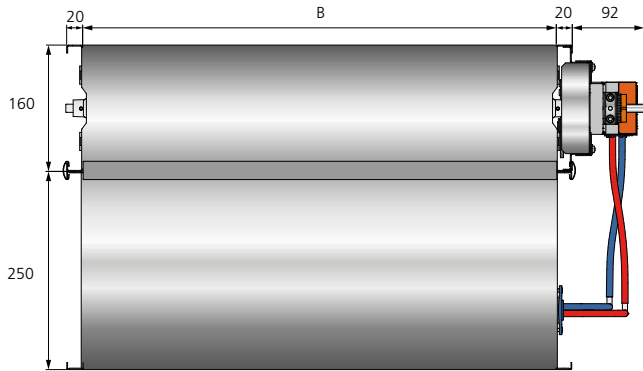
Abmessungen (mm), REACT V BMP rechteckig.
